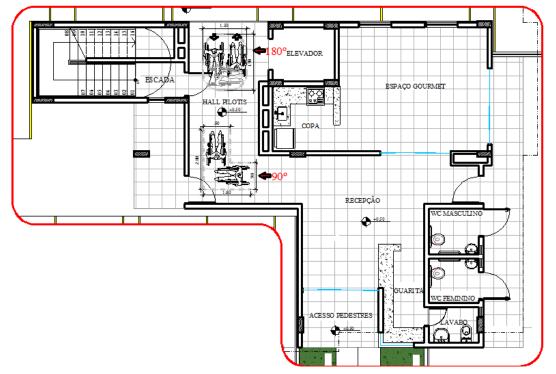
Manobra com deslocamento de 90° e 180° - pavimento térreo (Detalhe 08)
